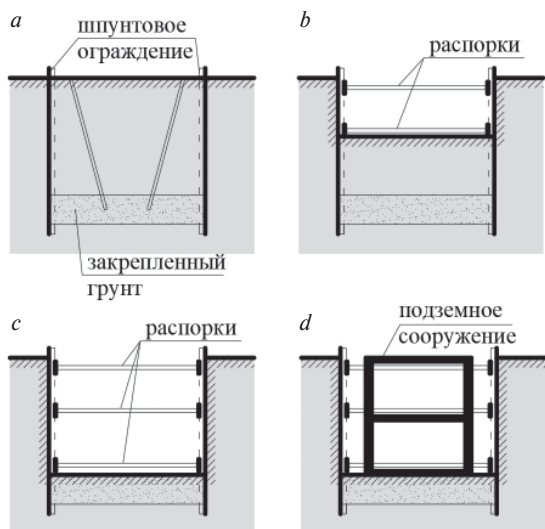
Возведение подземного сооружения: а – устройство шпунтового ограждения; б, с – устройство котлована, откапывание грунта и установка распорок; д – устройство подземного сооружения в котловане
